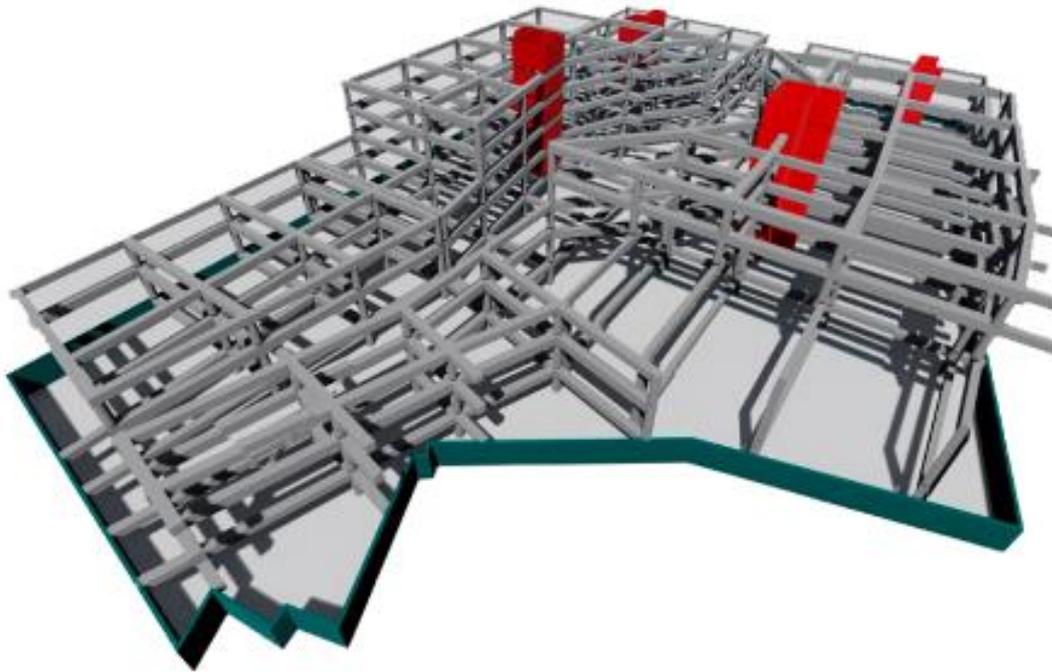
Casco estructural, sistema porticado del proyecto (Fuente: Elaboración propio, 2020).
